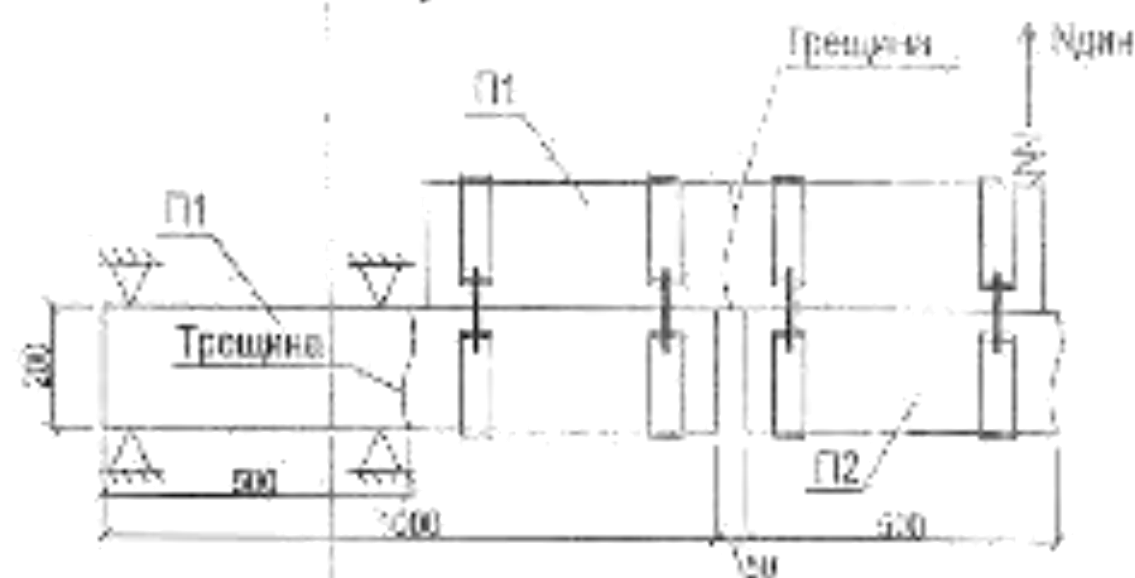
Схемы испытательных блоков с стеклопластиковой арматурой.
